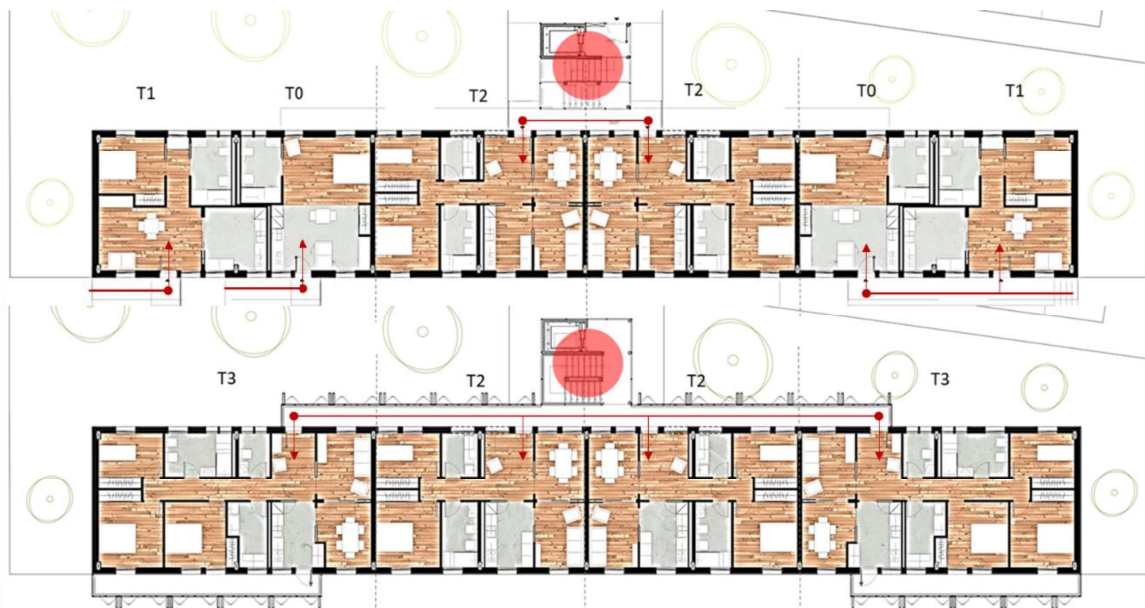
Planta (em cima) piso térreo e (em baixo) piso tipo - tipologias e acessibilidade.
